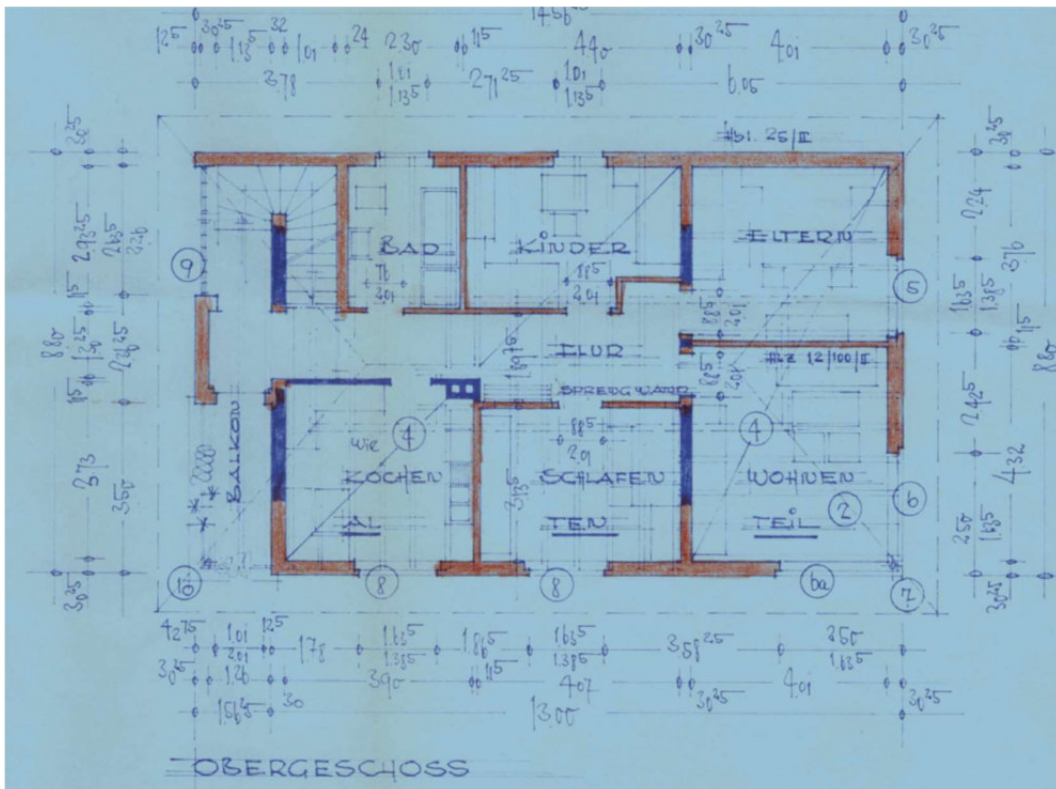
Grundriss-skizze Obergeschoss
